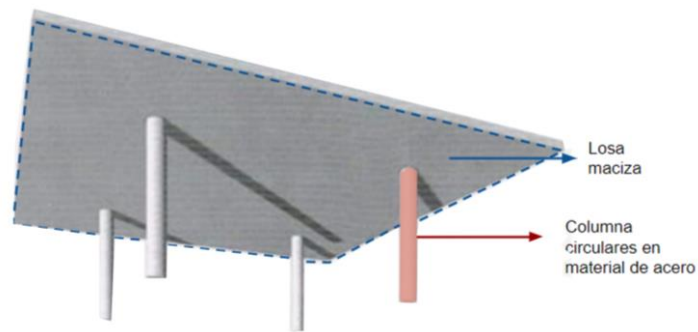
Lineamiento en estructura arquitectónica 1. Fuente: Elaboración propia.
